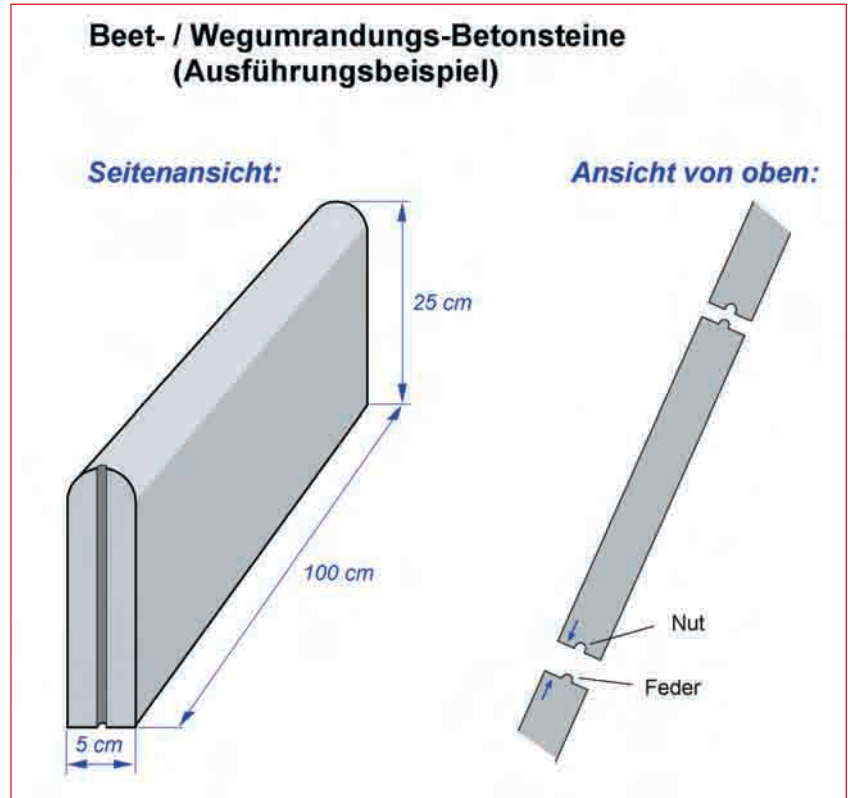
Beet-/Wegumrandungs-Betonsteine, die auch als Rasenkanten oder Beeteinfassungen bezeichnet werden, sind meist 1 m lang, 5 cm stark und wahlweise 20 oder 25 cm breit (= tief).
